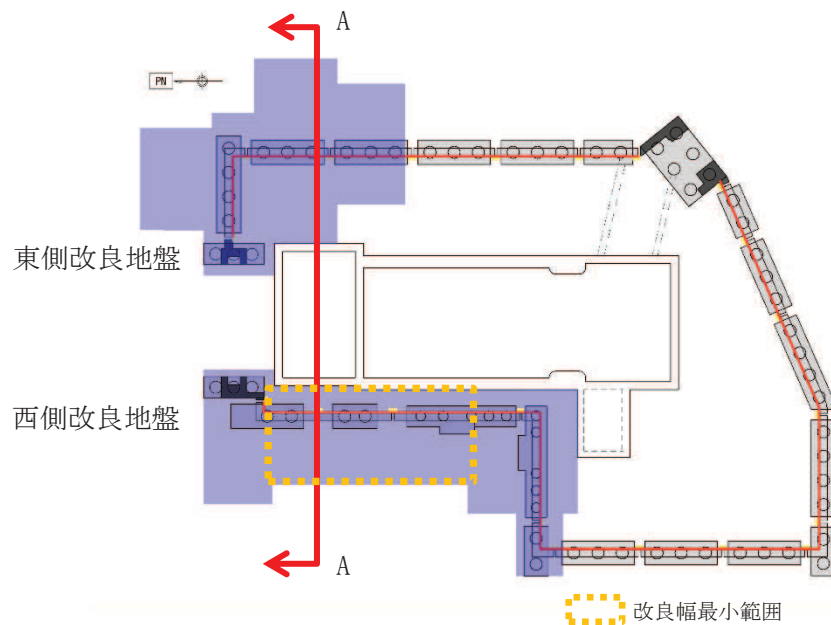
第2号機放水立坑改良地盤評価対象断面 平面図
